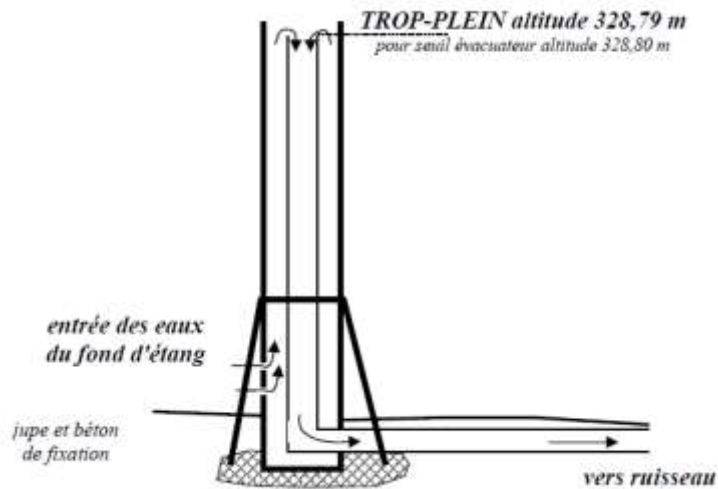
Type d'aménagement possible (Source: ADAM, 2014 - Dossier Loir sur l'eau du plan d'eau du Nizy)
